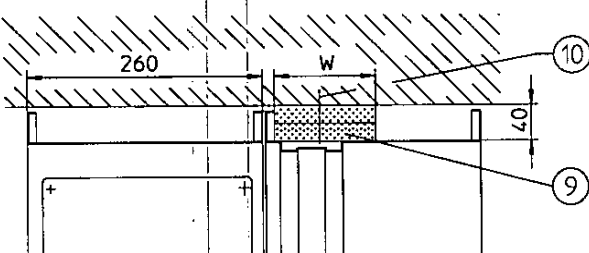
Wand- / Deckenanschluss mit Isolierstoffstreifen
